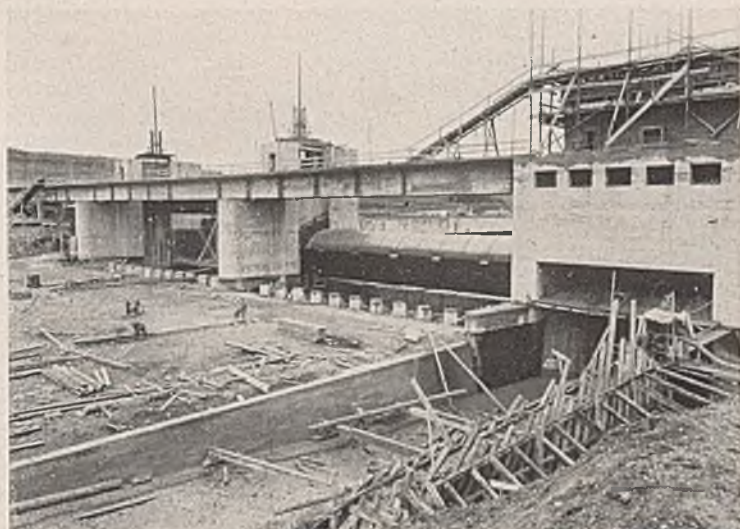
Staustufe Aldingen. Schützenwehr mit Eisenbetonbrücke und Kraftwerk im Bau. Unterwasserseite.
